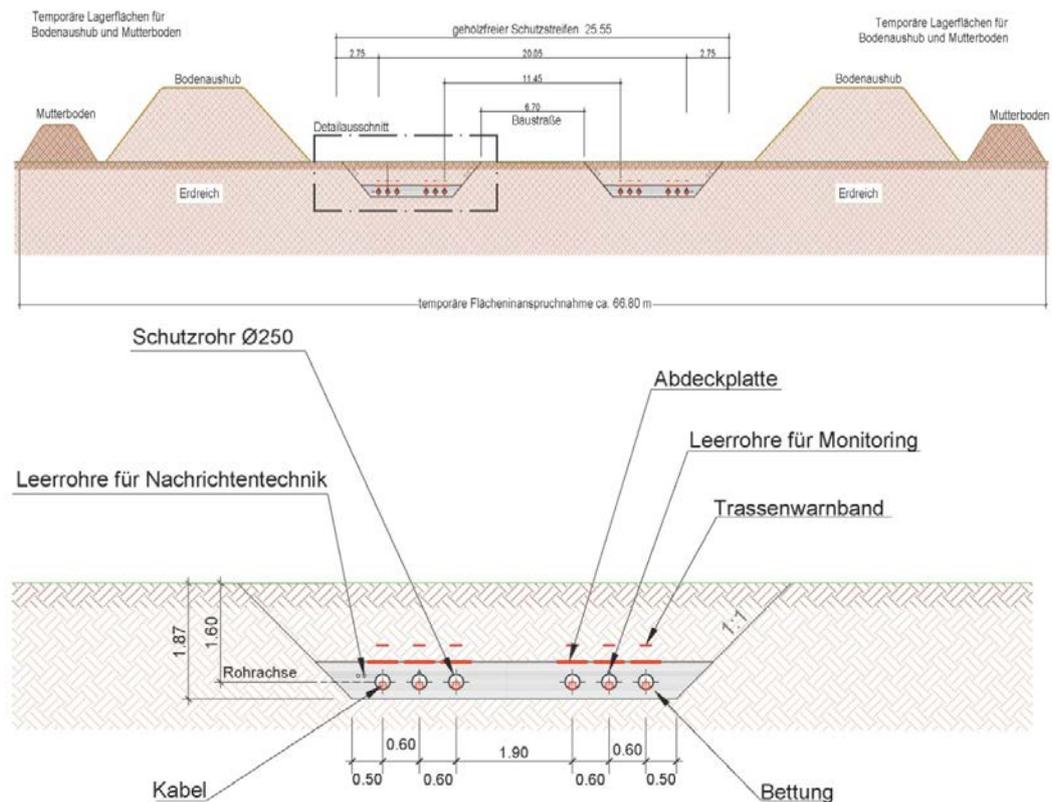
Schema eines Regelgrabenprofils bei offener Bauweise (Detailansicht unten)
